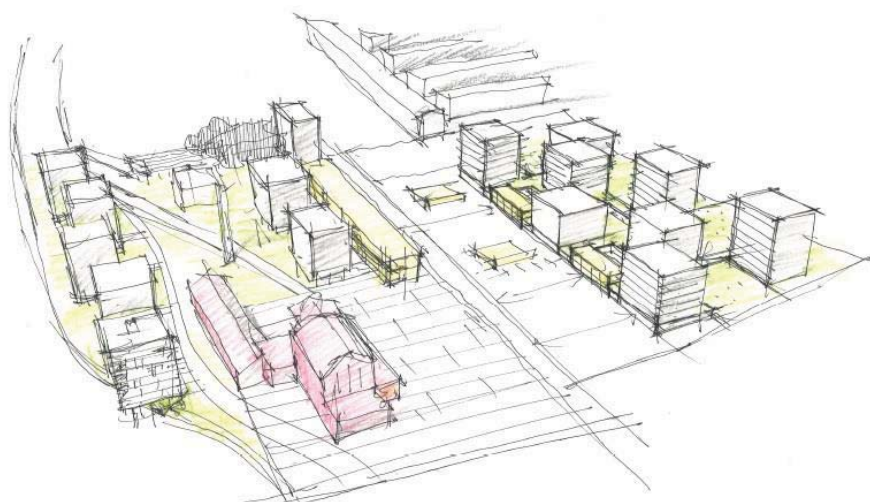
Städtebauliche Masterplan „Timber in Town“<sup>287</sup>
